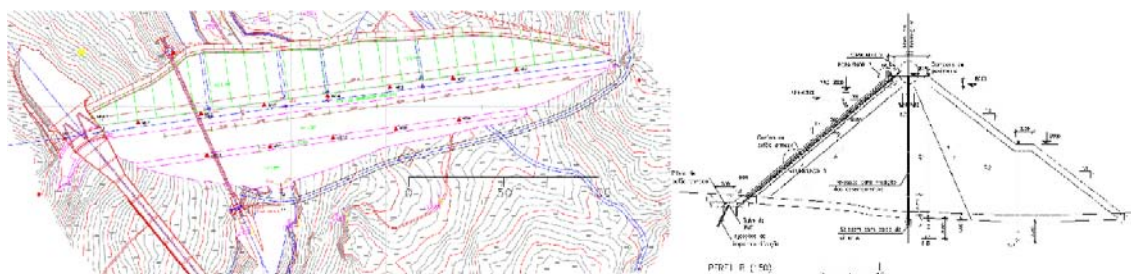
Planta e Perfil Transversal Tipo da Barragem do Pinhão
